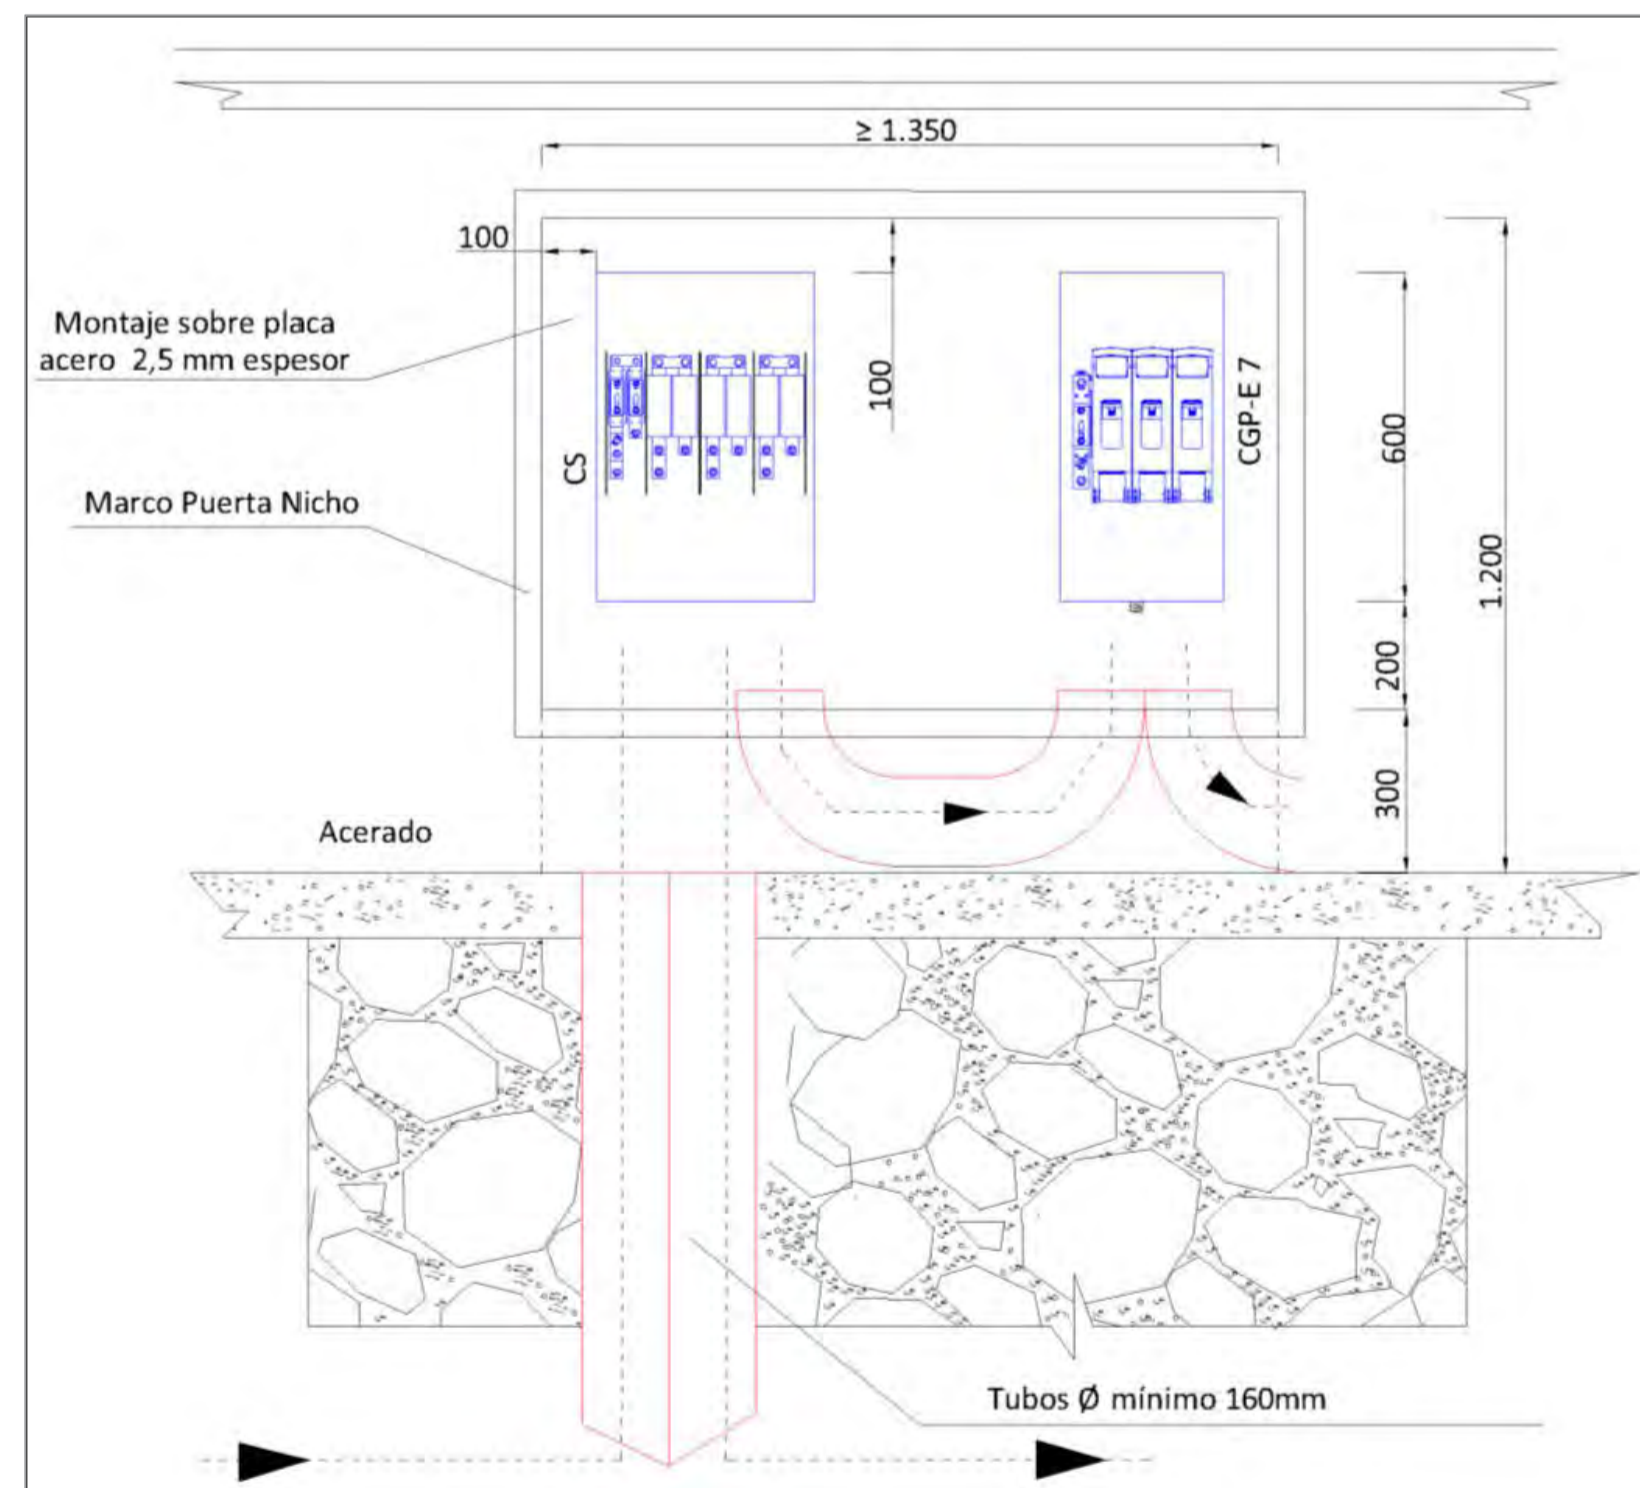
Instalación CGP y CS montaje horizontal. Alzado.
